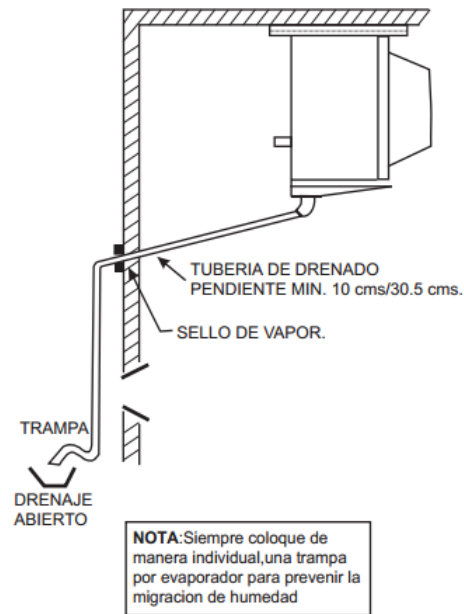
Colocación correcta de la tubería de drenado de los condensados.
